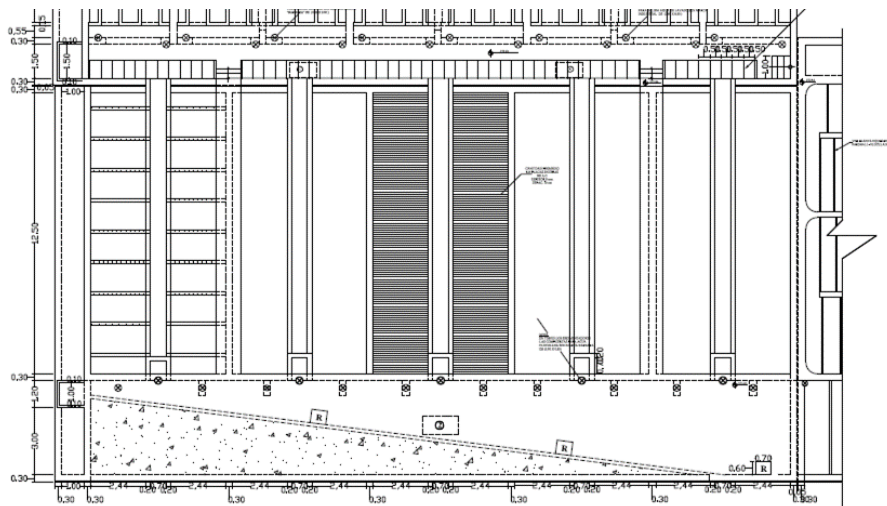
vista en corte y planta de los 5 decantadores de cada módulo de tratamiento
